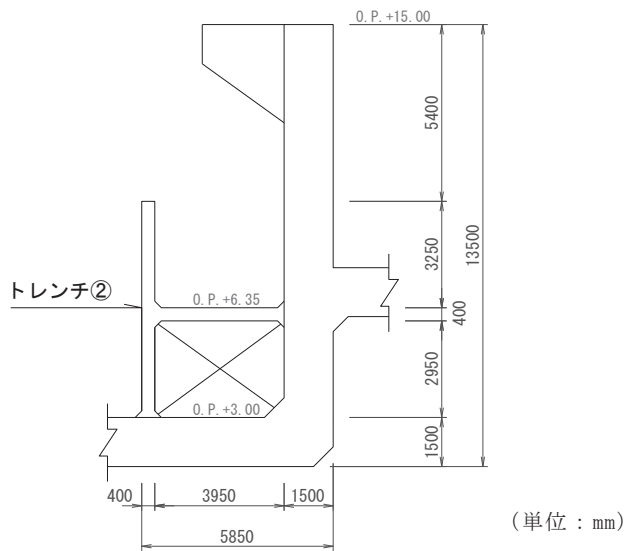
(8) 補機ポンプエリア断面図 (⑧—⑧断面)
